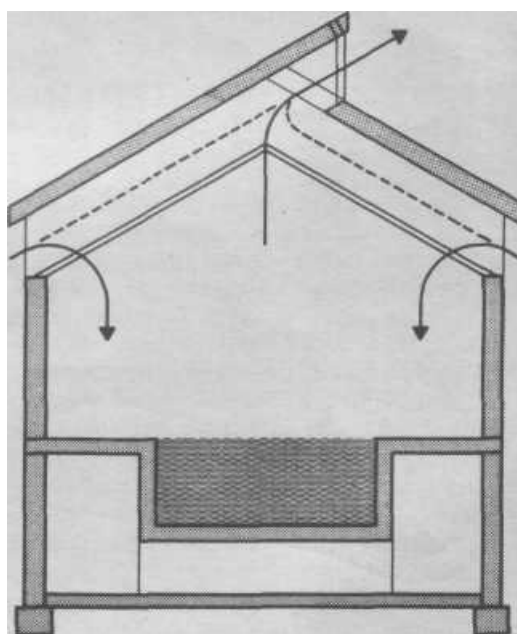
Плавательный бассейн с холодной кровлей и легким подвесным потолком. Воздух помещения проникает через подвесной потолок в холодную кровлю и затем наружу
